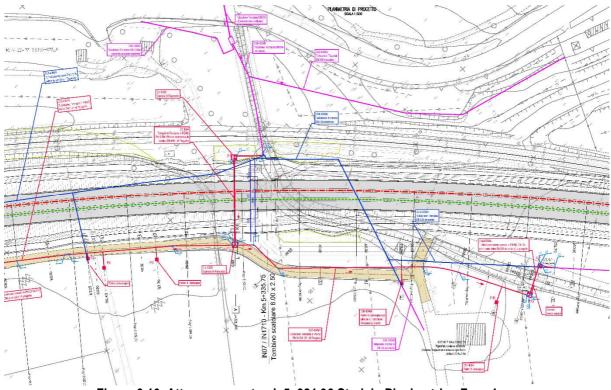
Attraversamento pk 5+321.96 Stralcio Planimetrico Fase 1
